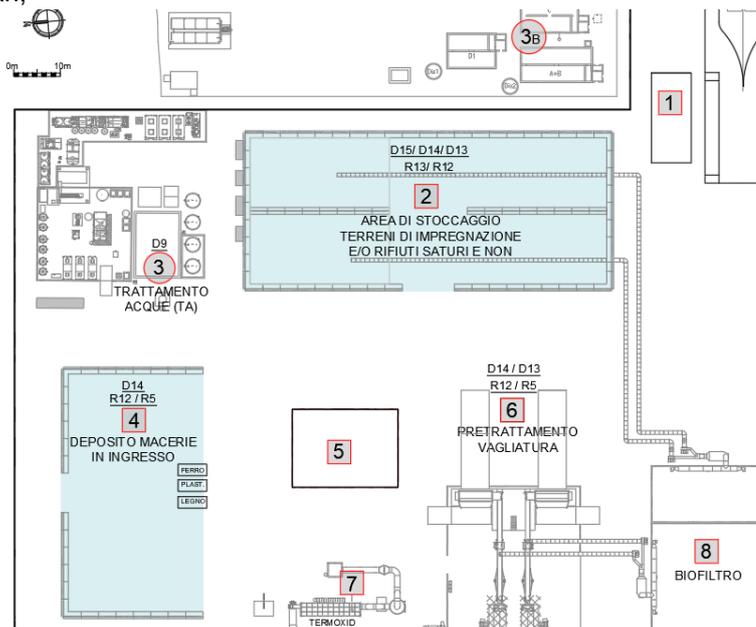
Stralcio planimetria Piattaforma con individuazione delle Zone 2 e 4 (estratto dalla Tav.02).
